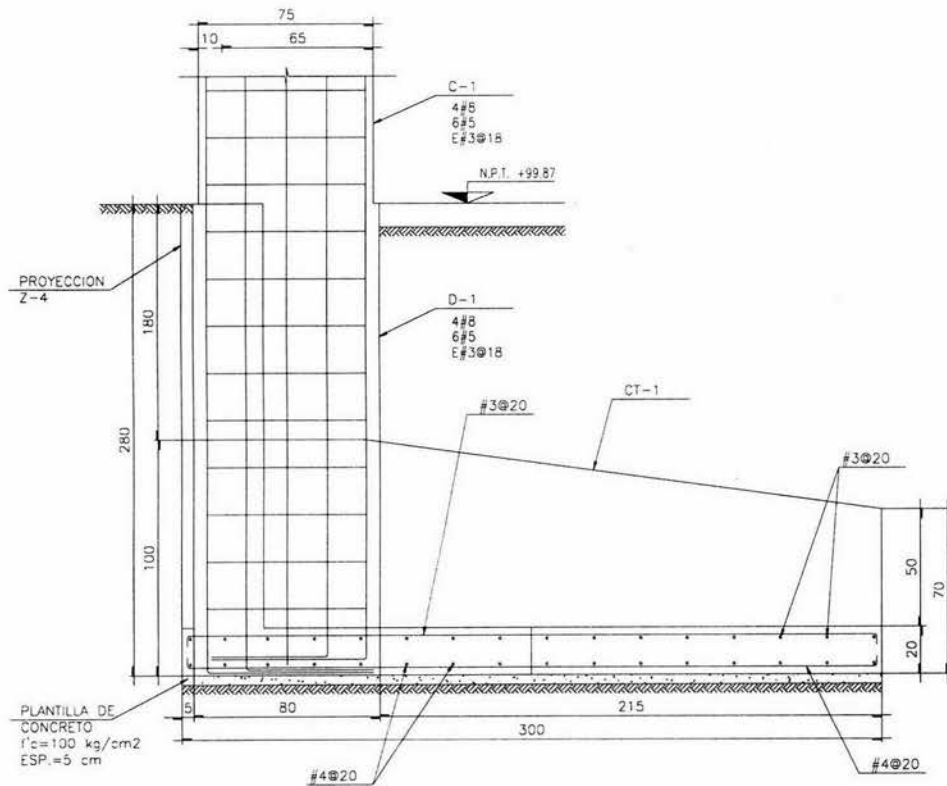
PLANO DE CIMENTACIÓN
